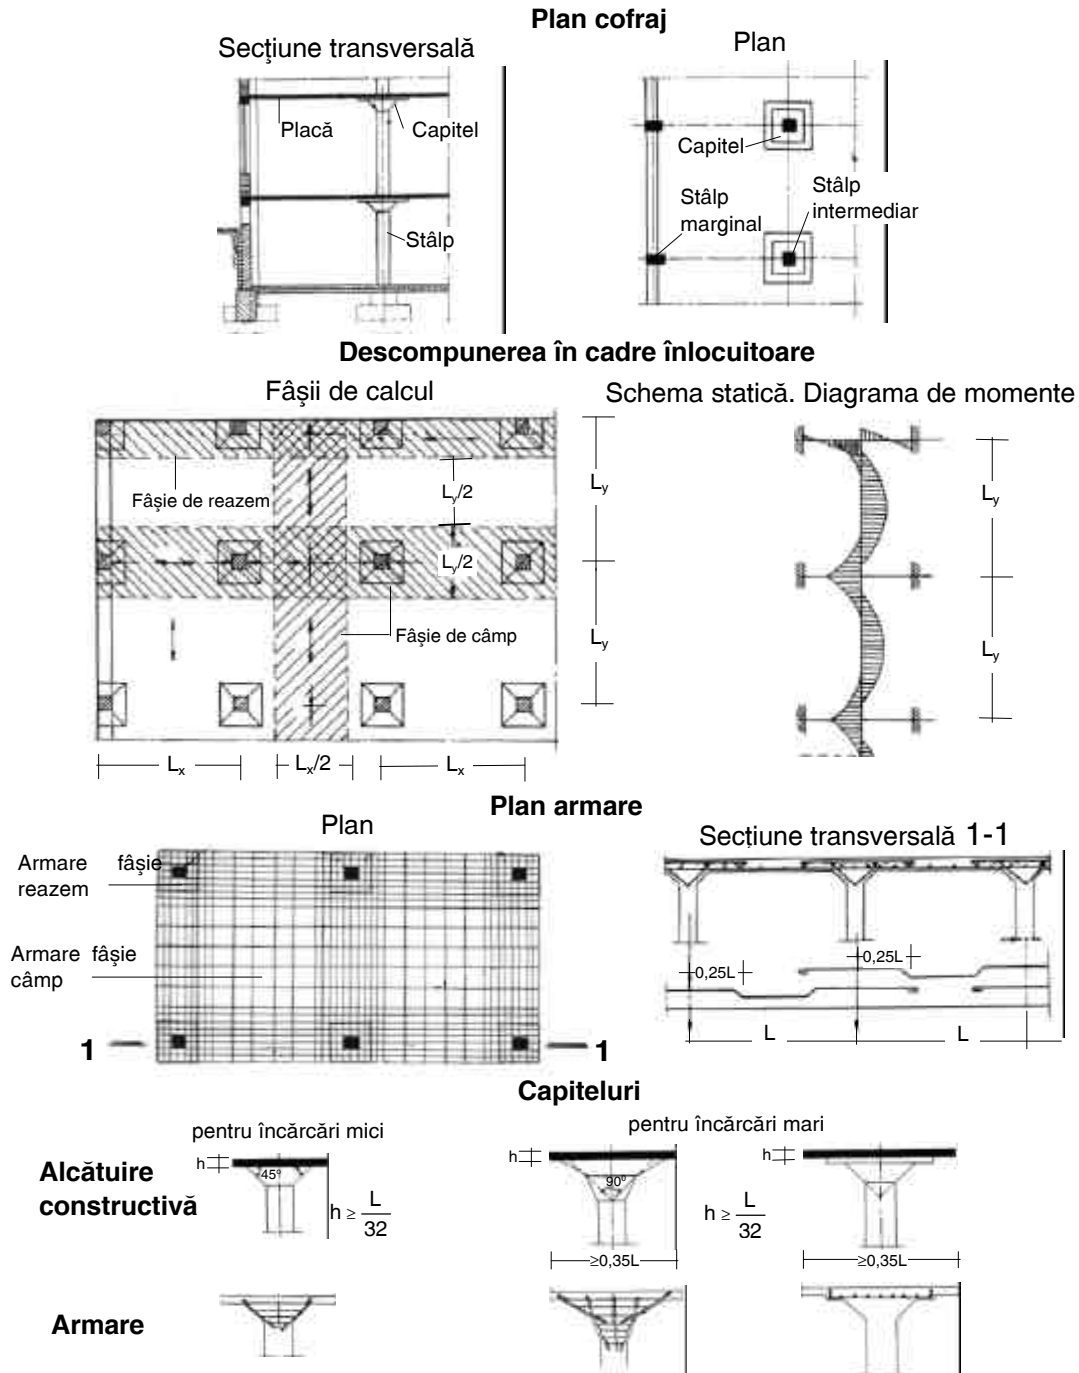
Planșeu tip ciuperi. Plan cofraj. Fâșii de calcul. Plan armare. Tipuri de capiteluri, alcătuire constructivă și armare.
